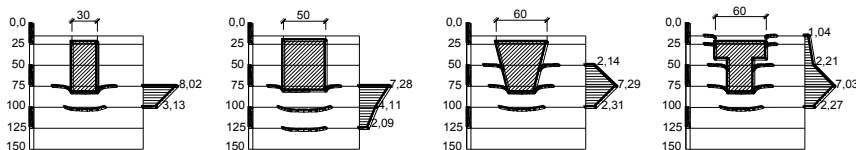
Деформации грунта основания при работе моделей фундаментов
